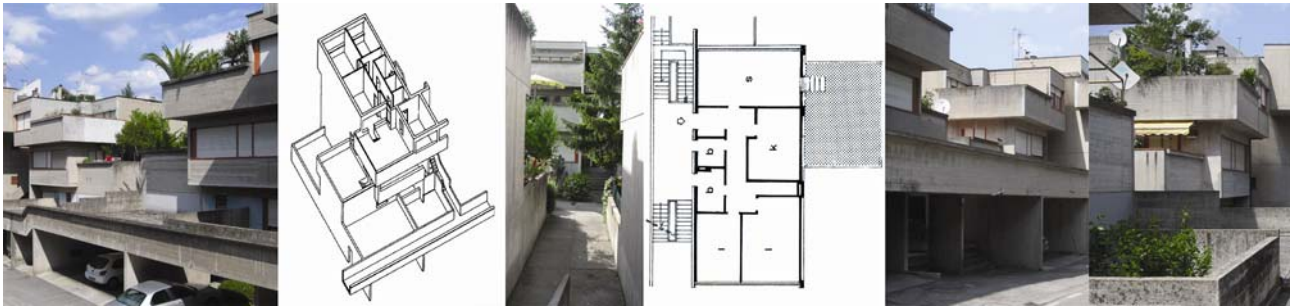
Immagini, assonometria e pianta della tipologia 3R.
